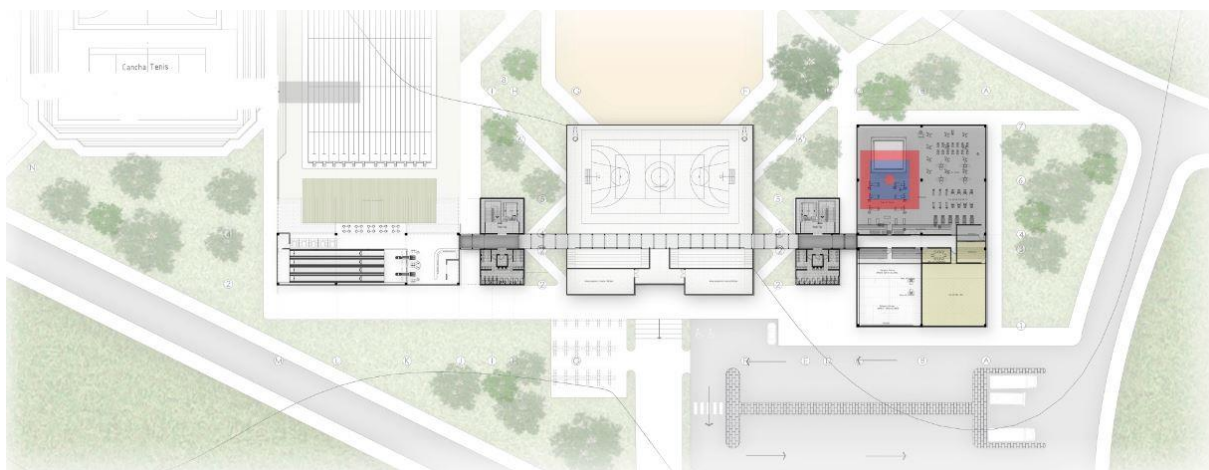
Planta 3er Nivel / Autoría propia (2017)
